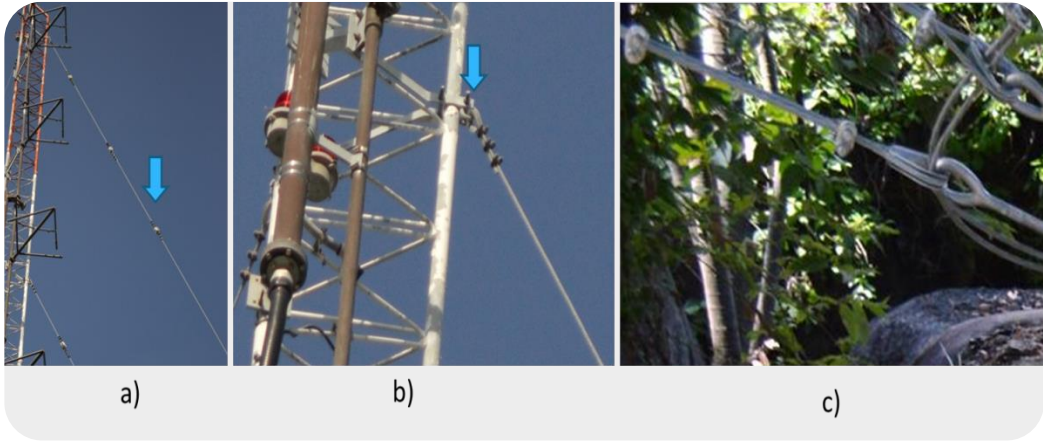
a) Aisladores. b) Amarre en retenida. c) Amarre en ancla.
